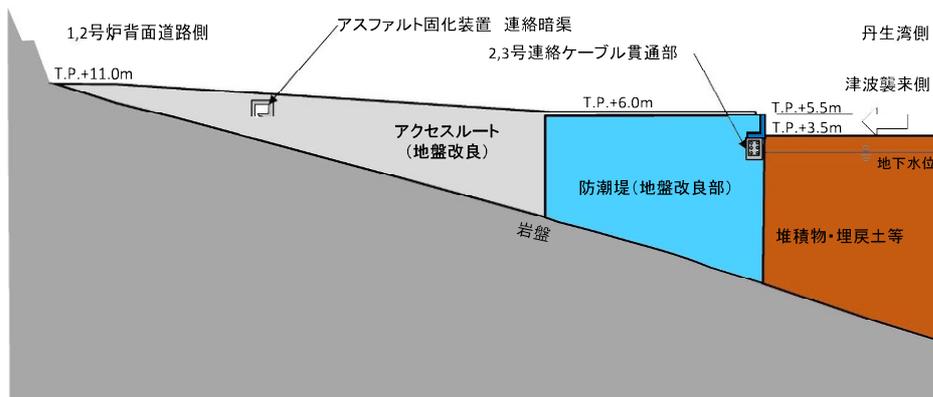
地盤改良部 断面図 (D-D 断面)
